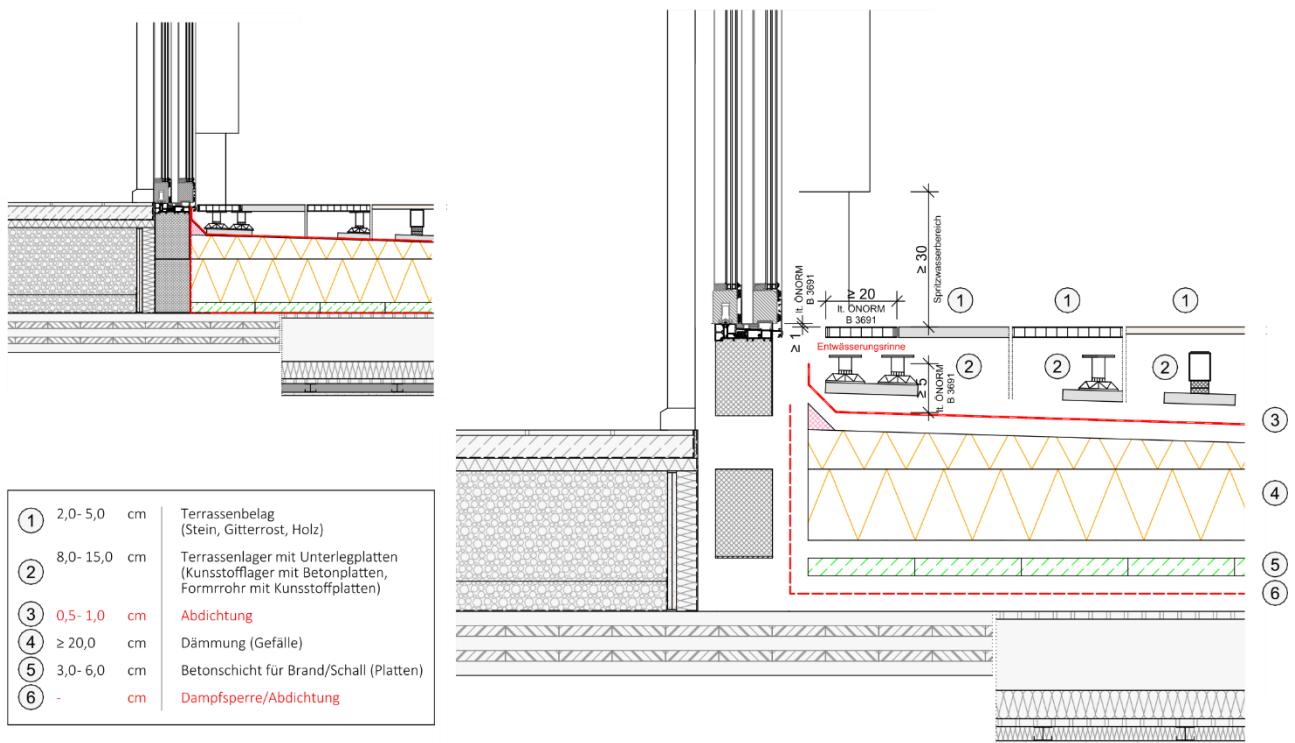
Detailausbildung – bodentiefer Fenster-/ Türanschluss teilgeschützt
